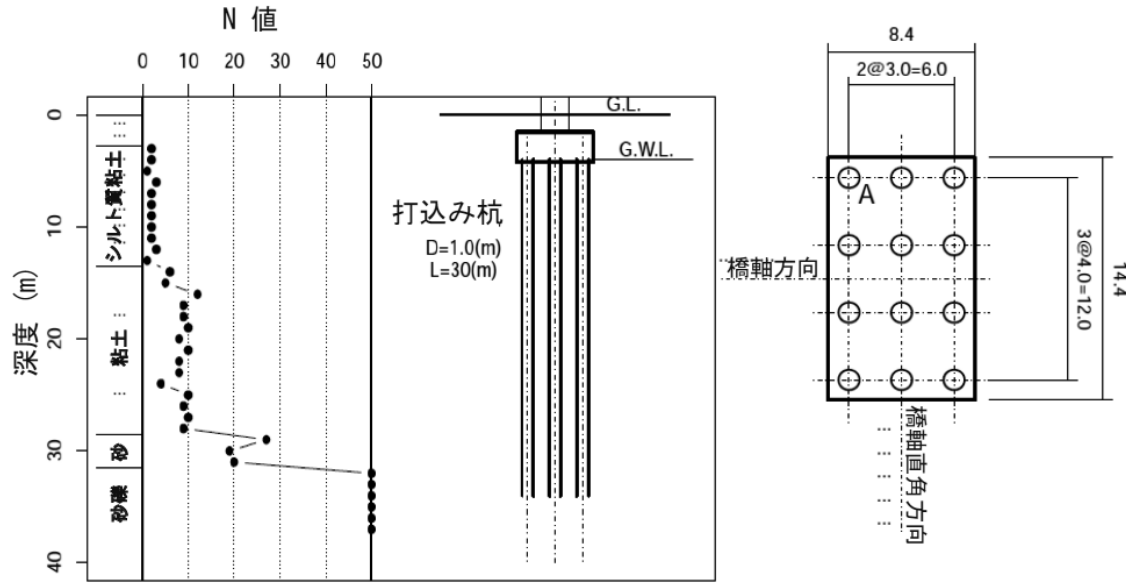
土質柱状図，杭基礎の断面図と平面図
